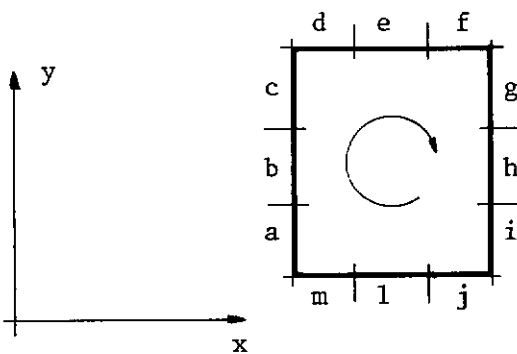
Posição das Barras e Lajes nos Bordos de Uma Laje.
